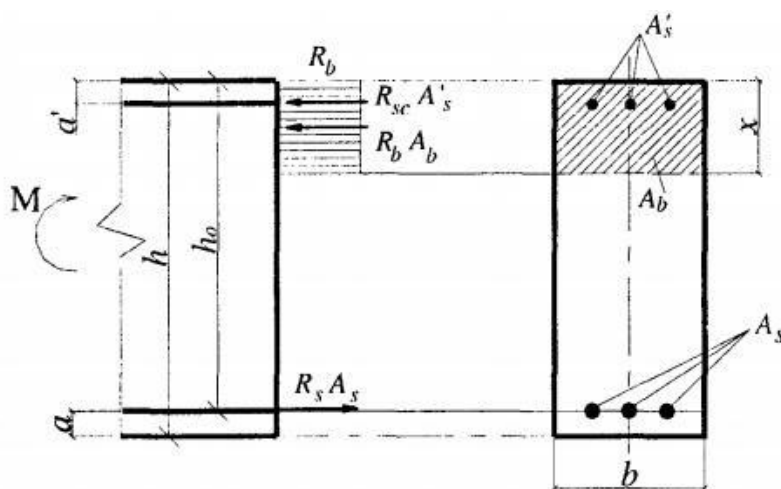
Поперечное прямоугольное сечение изгибаемого железобетонного элемента
